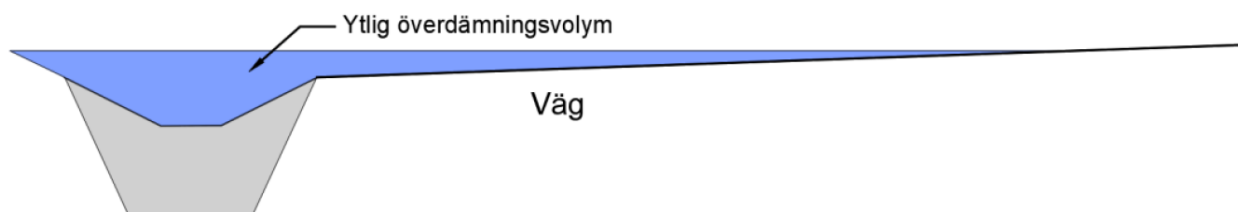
Föreslagen skyfallsled längs fastighet Östra Gårdsstånga 8:11 i planerad situation
